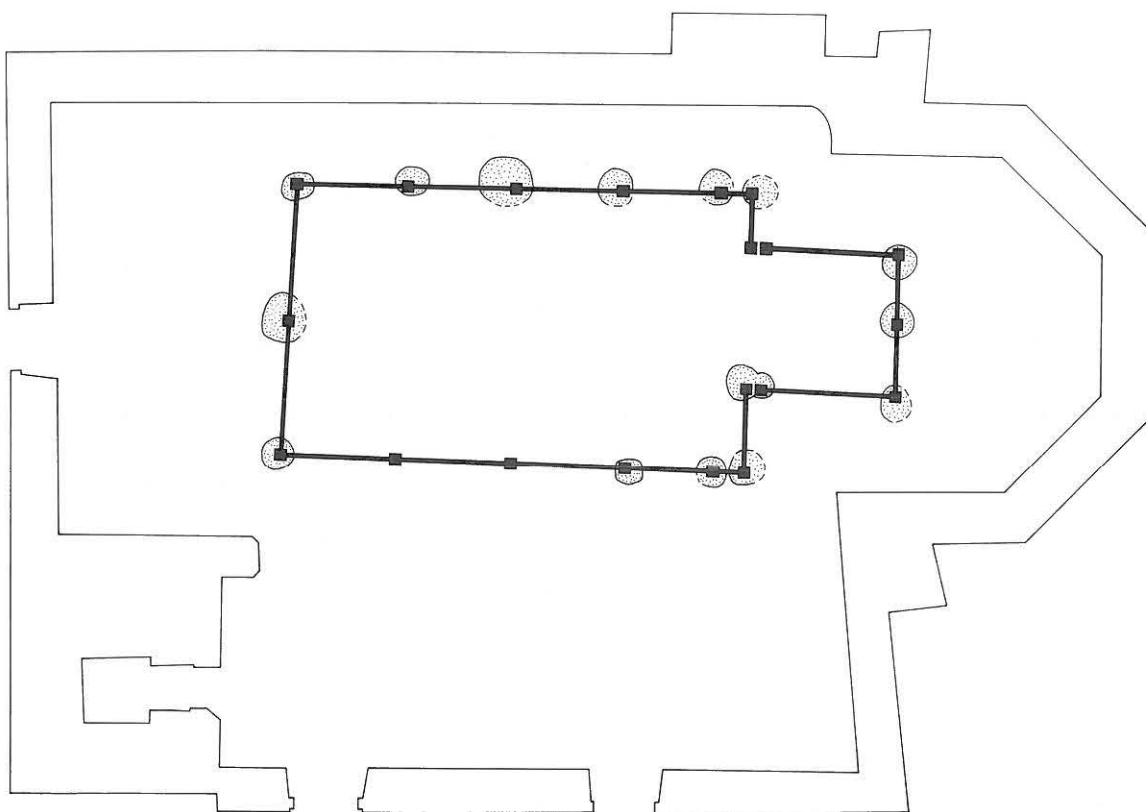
Rekonstruktion des Grundrisses der Holzkirche I C. M. 1:150.
